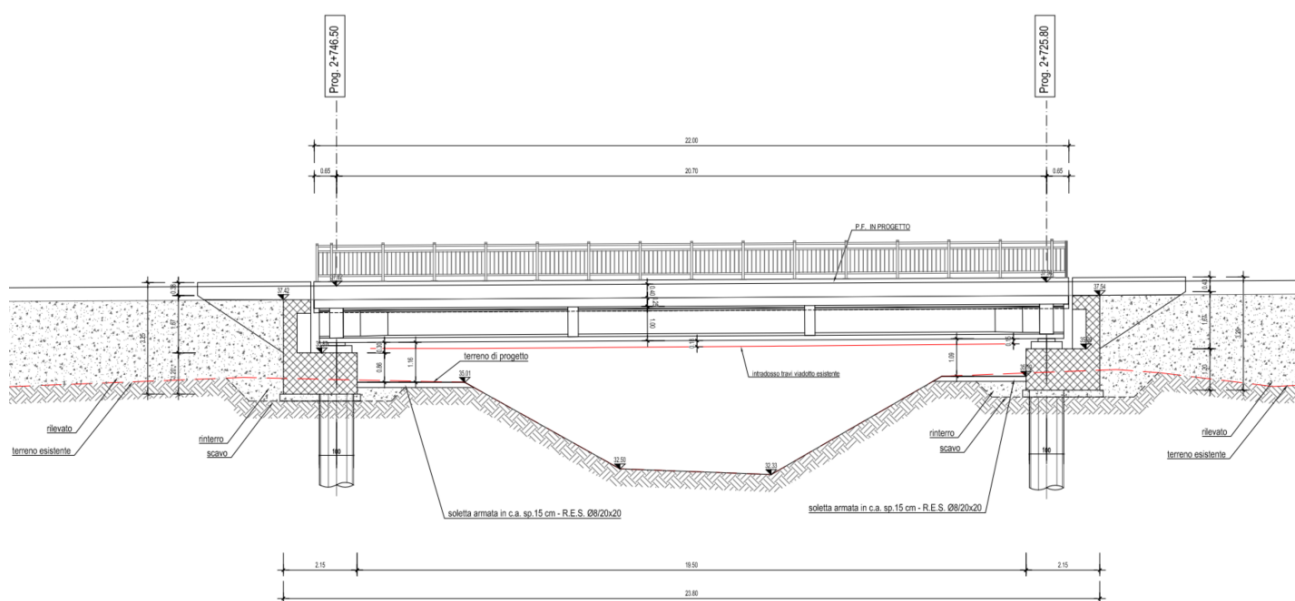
PROSPETTO DEL PONTE IN PROGETTO SUL COLLETTORE PRINCIPALE ACQUE BASSE
